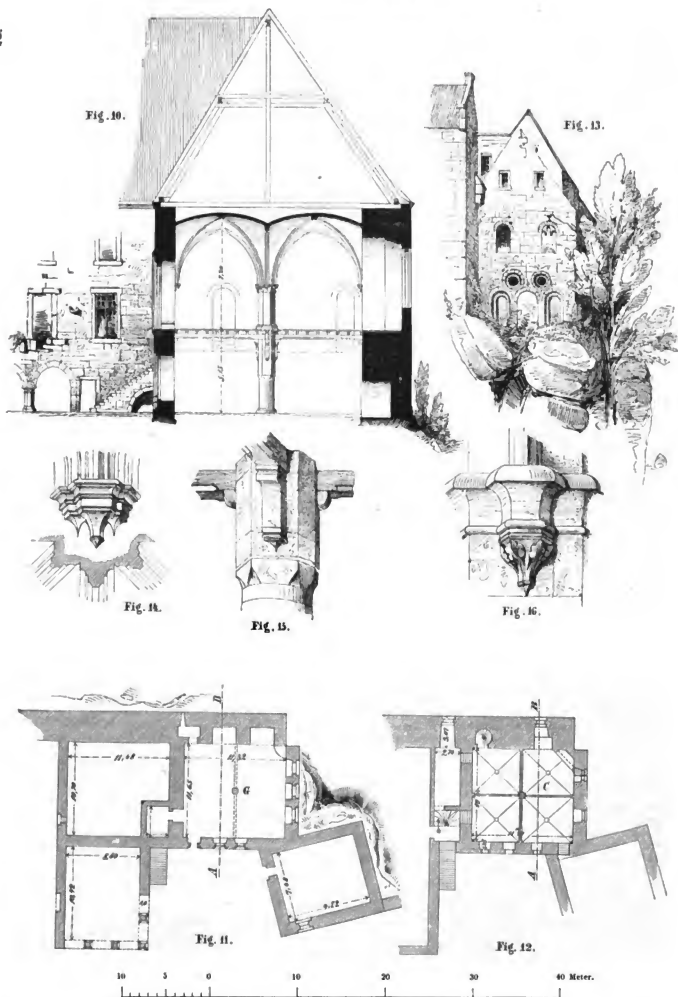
Durchschnitt durch die Kronburg nach der Linie A-B. — Fig. 11. Grundriss vom Erdgeschoss der Kronburg. — Fig. 12. Grundriss vom zweiten Geschoss. — Fig. 13. Ansicht des ältesten Theiles der Kronburg von der Nordseite. — Fig. 14. Wandhohle des Saales C. — Fig. 15. Detail des Pfeilers G. — Fig. 16. Pfeilerkapitel des Saales C. —
